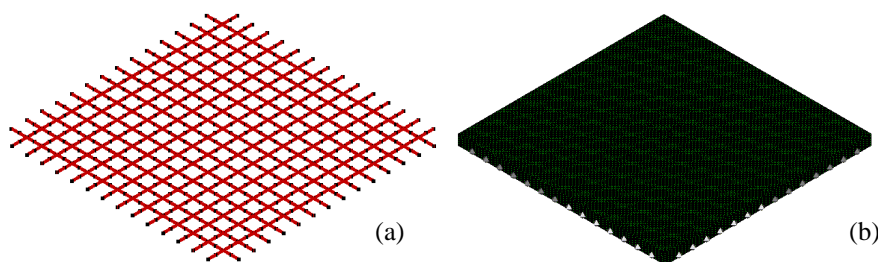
Modelo de EF (a) Armadura (b) Hormigón.
